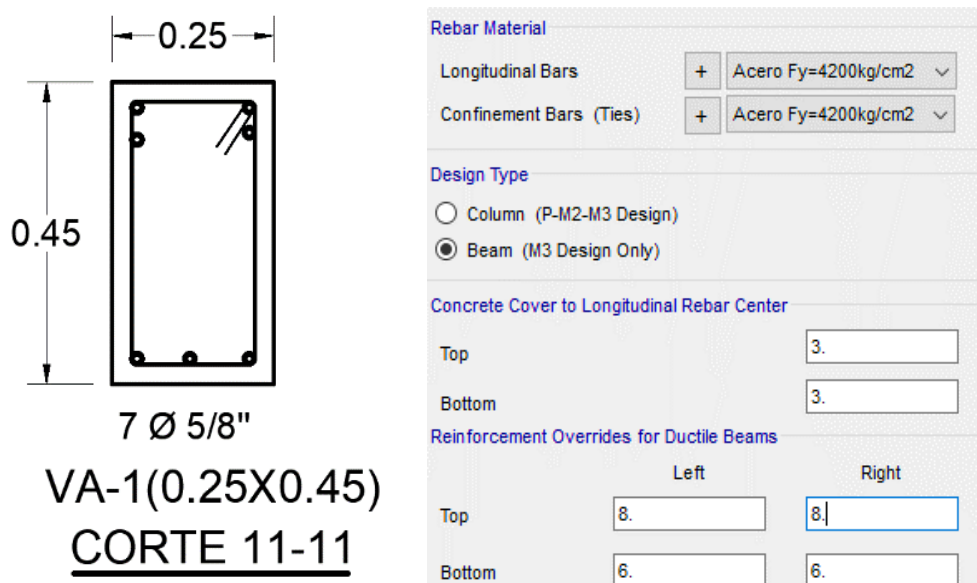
Detalles de refuerzo de la viga (VA-1). Fuente: Propia.
